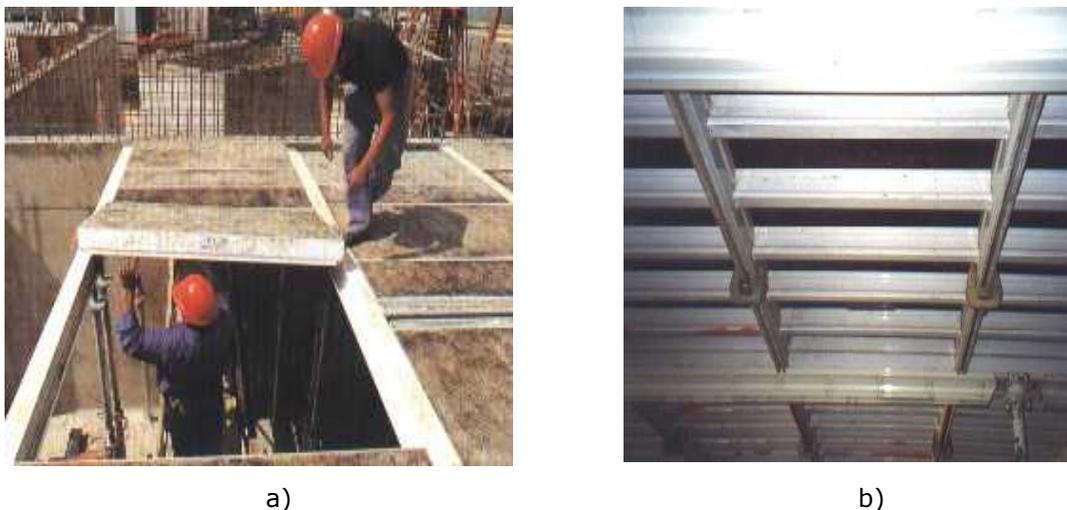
Sistema modular para lajes: a) montagem dos painéis apoiando-os em vigas metálicas; b) vista inferior do sistema montado.
